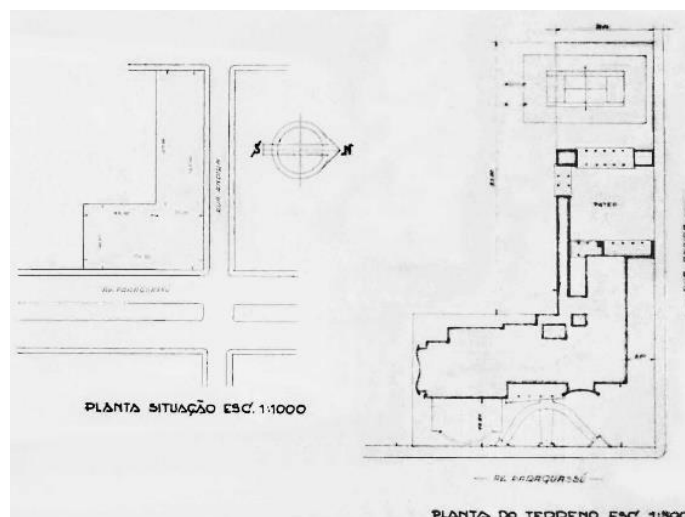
Planta de situação e planta do terreno da SACC, 1959.
